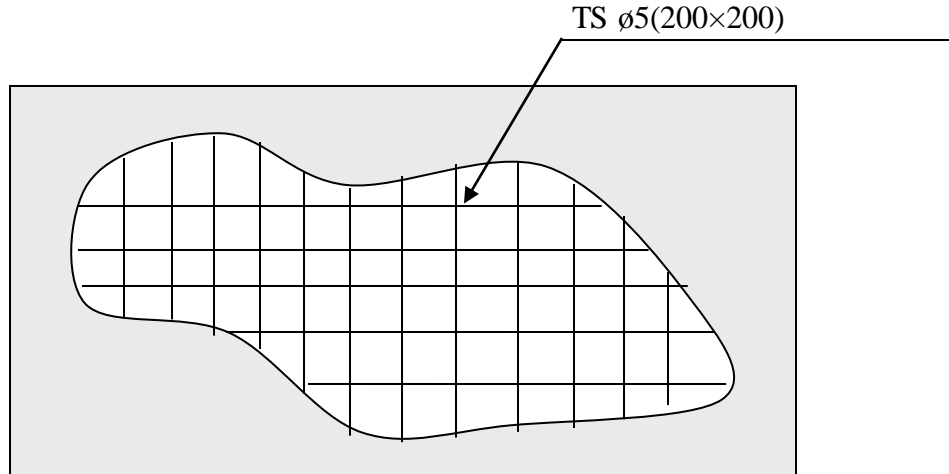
La disposition constructive des armatures de la dalle de compression
